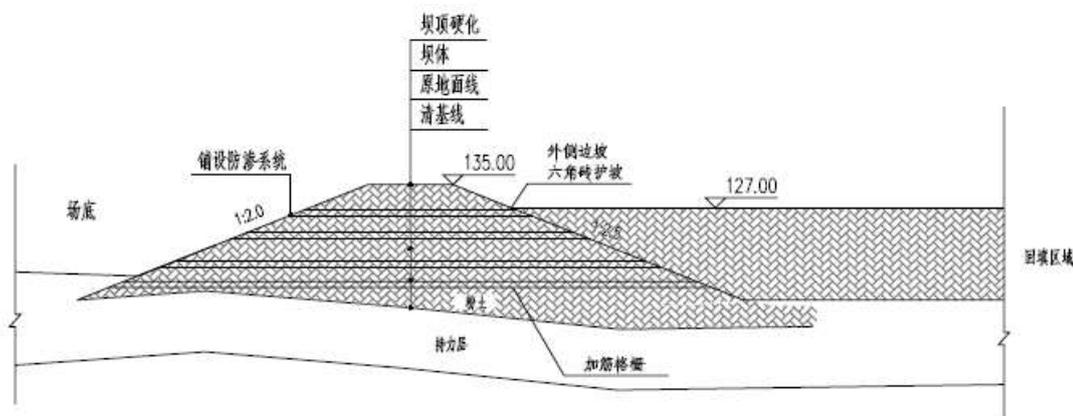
飞灰填埋区垃圾坝结构断面图
